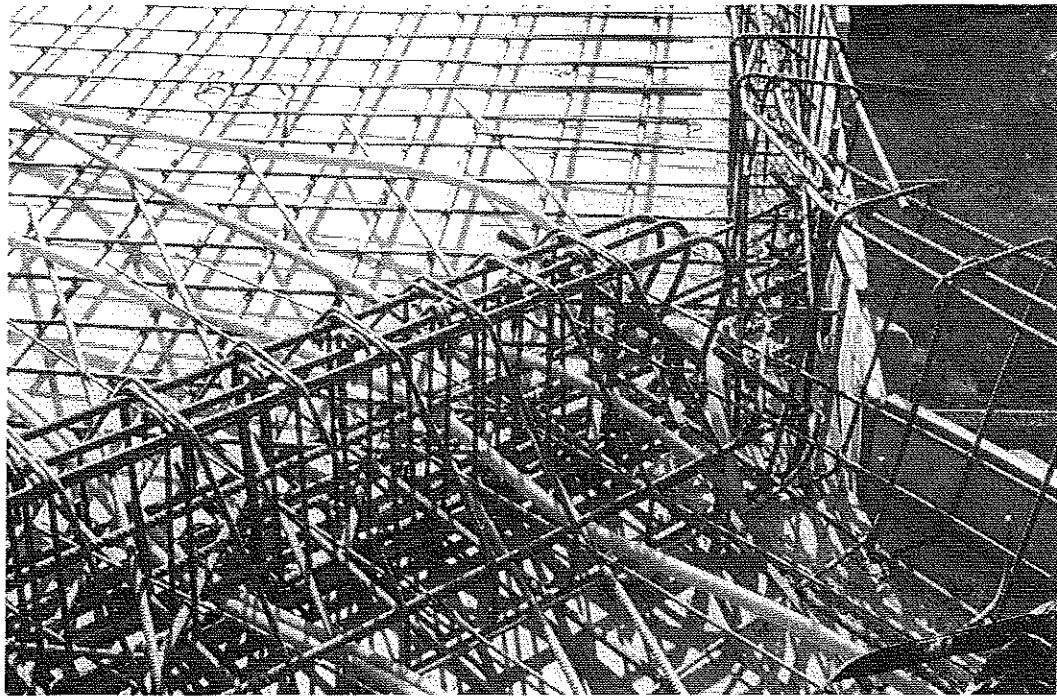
Dispositions d'appui d'une poutre en allège. © J. Putatti
